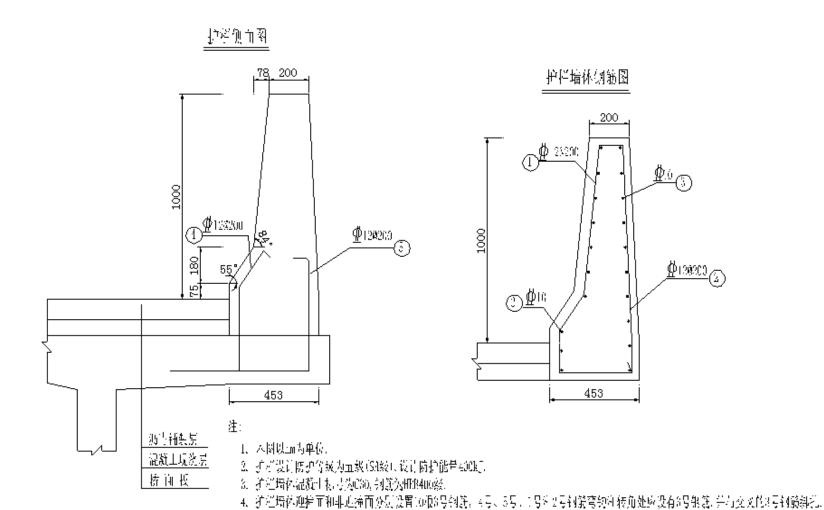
五 (SA) 级 F 型桥梁混凝土护栏设计示例 (尺寸单位: mm)
